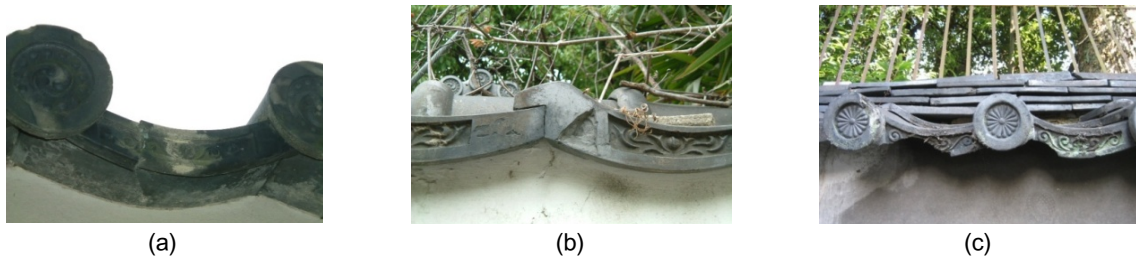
鎌軒瓦のひび割れ・剥離
